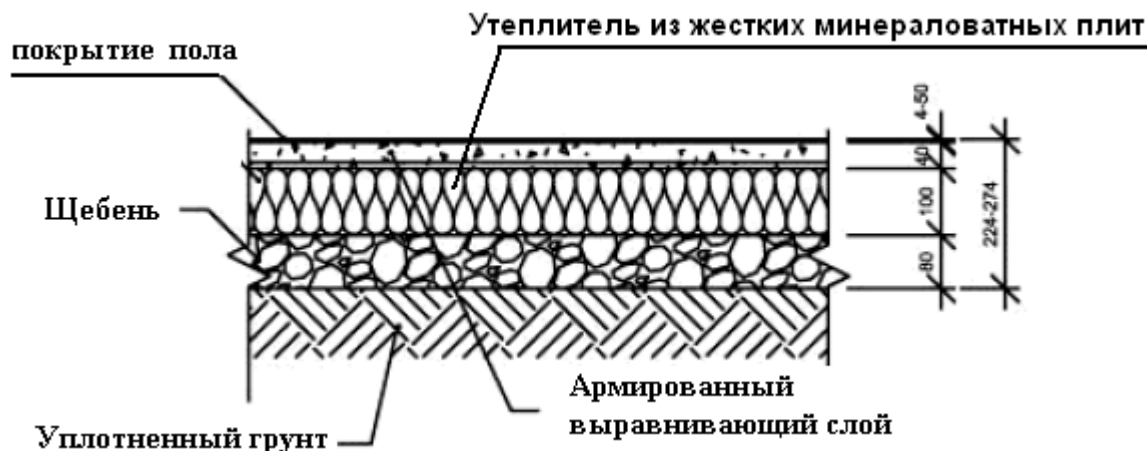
Конструктивное решение утепления пола первого этажа
